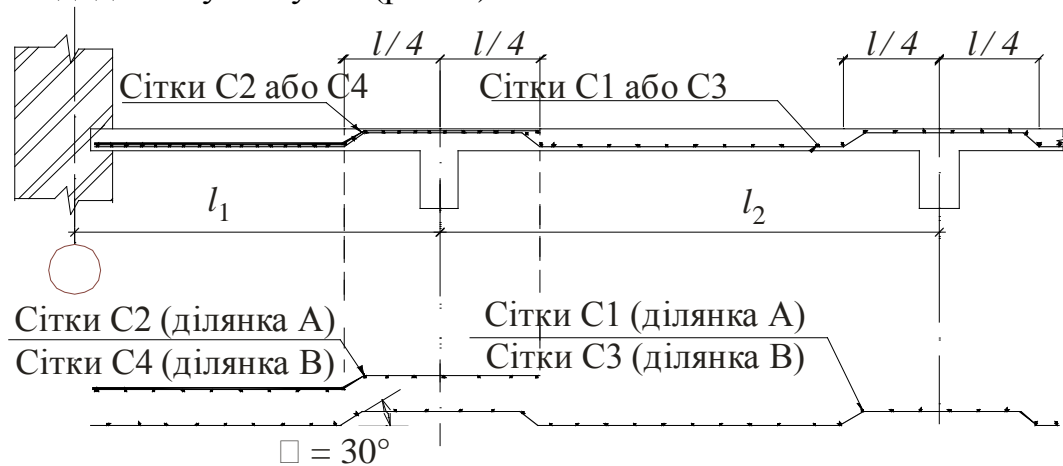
Армування плити рулонними зварними сітками з поздовжньою робочою арматурою
